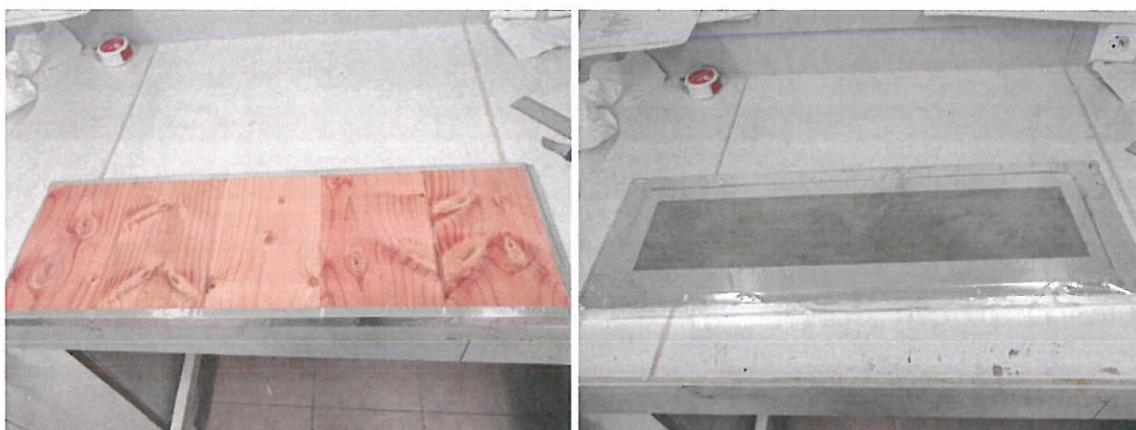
Epreuve d'essai 14/1216C/2 après découpe et colmatage
